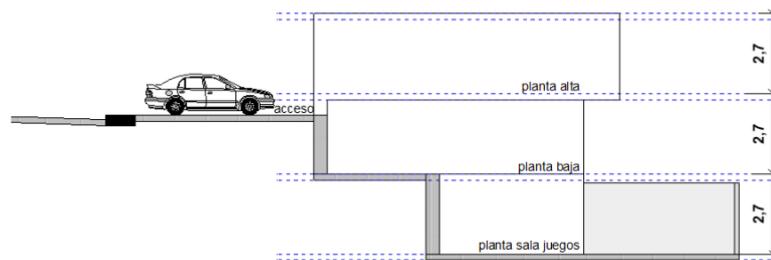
Plano 9 Corte casa tipo 2. Fuente: Construvicor Cia. Ltda.
